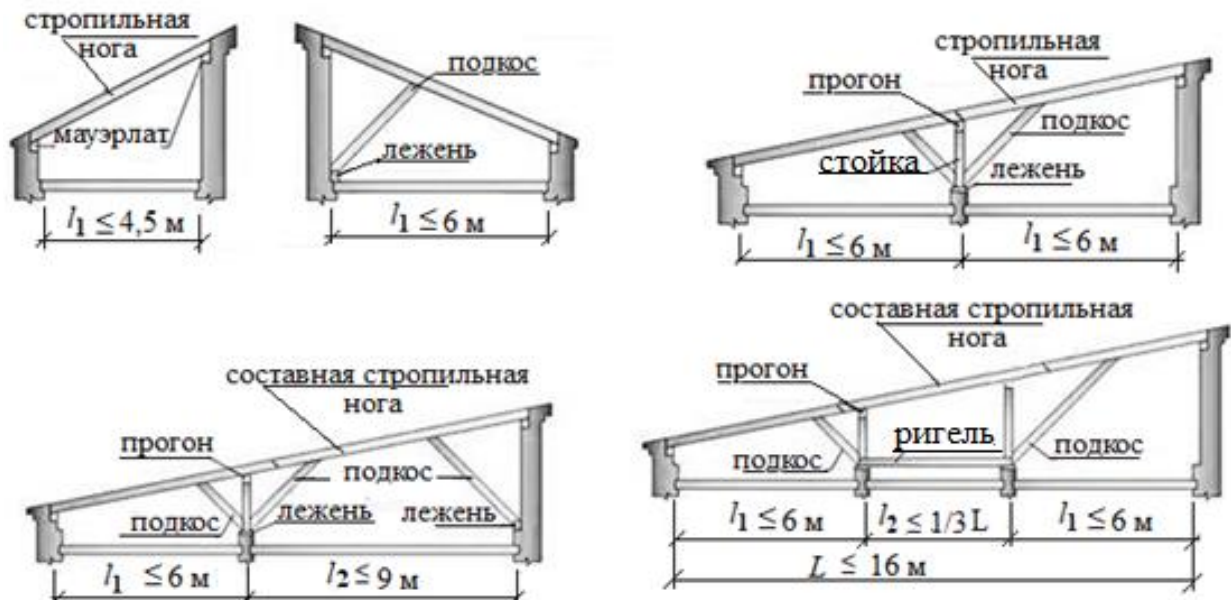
Схемы поперечных разрезов односкатных наслонных стропильных систем
